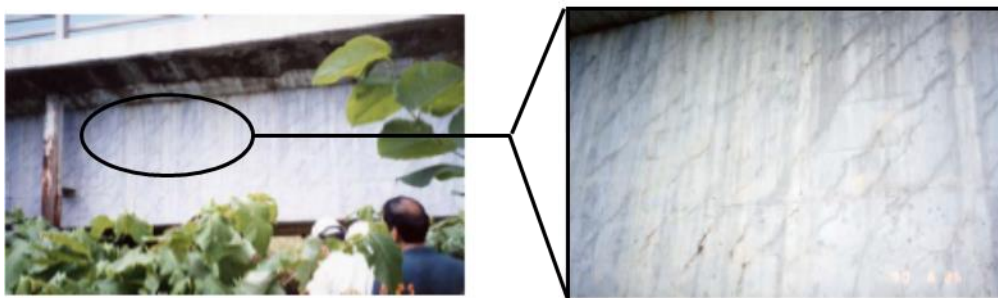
Fisuración por cortante en una viga de un puente de hormigón (De Silva 2008)
